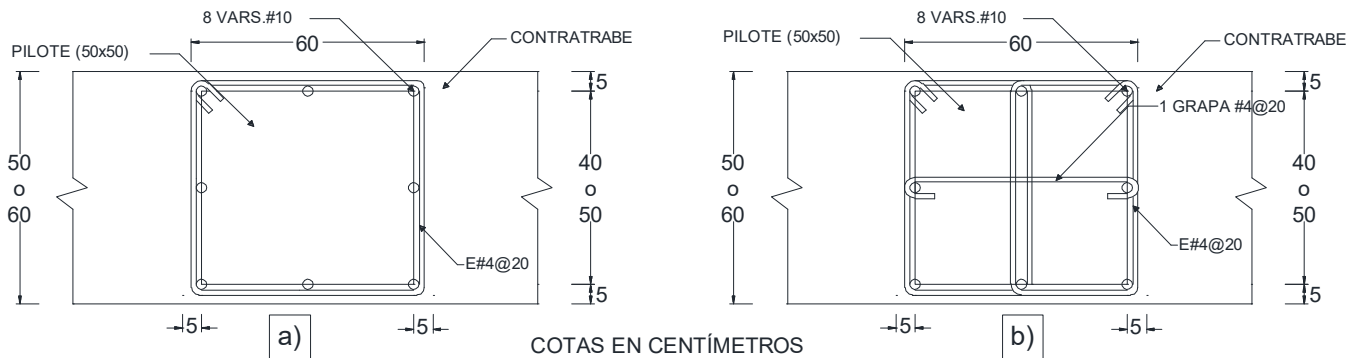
Corte lateral de contratraves utilizadas para la cimentación (Riobóo, 1995).
